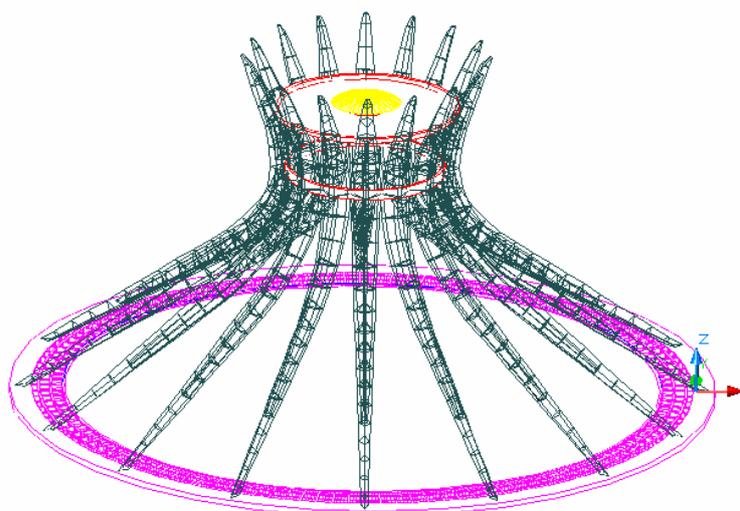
Sistema estrutural da Catedral – Anel de tração, estrutura em grelha, pilares, anel de compressão e laje de cobertura (Pessoa, 2002, p. 11)
